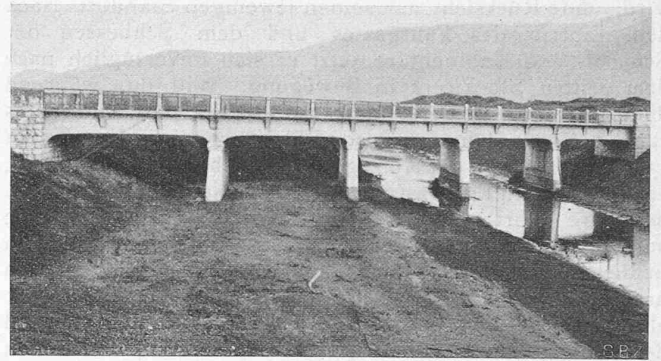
Agro Pontino; Eisenbeton-Strassenbrücke.
